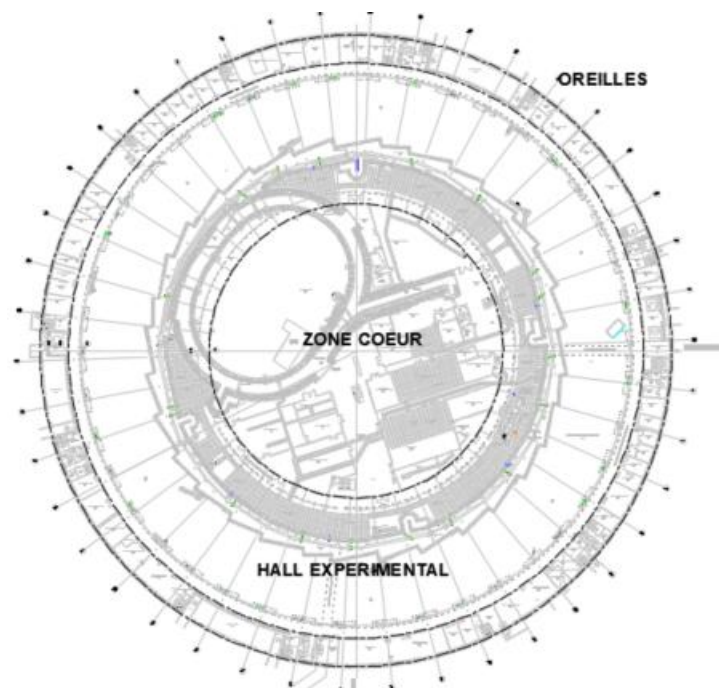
Extrait plan synchrotron niveau rez-de-chaussée
